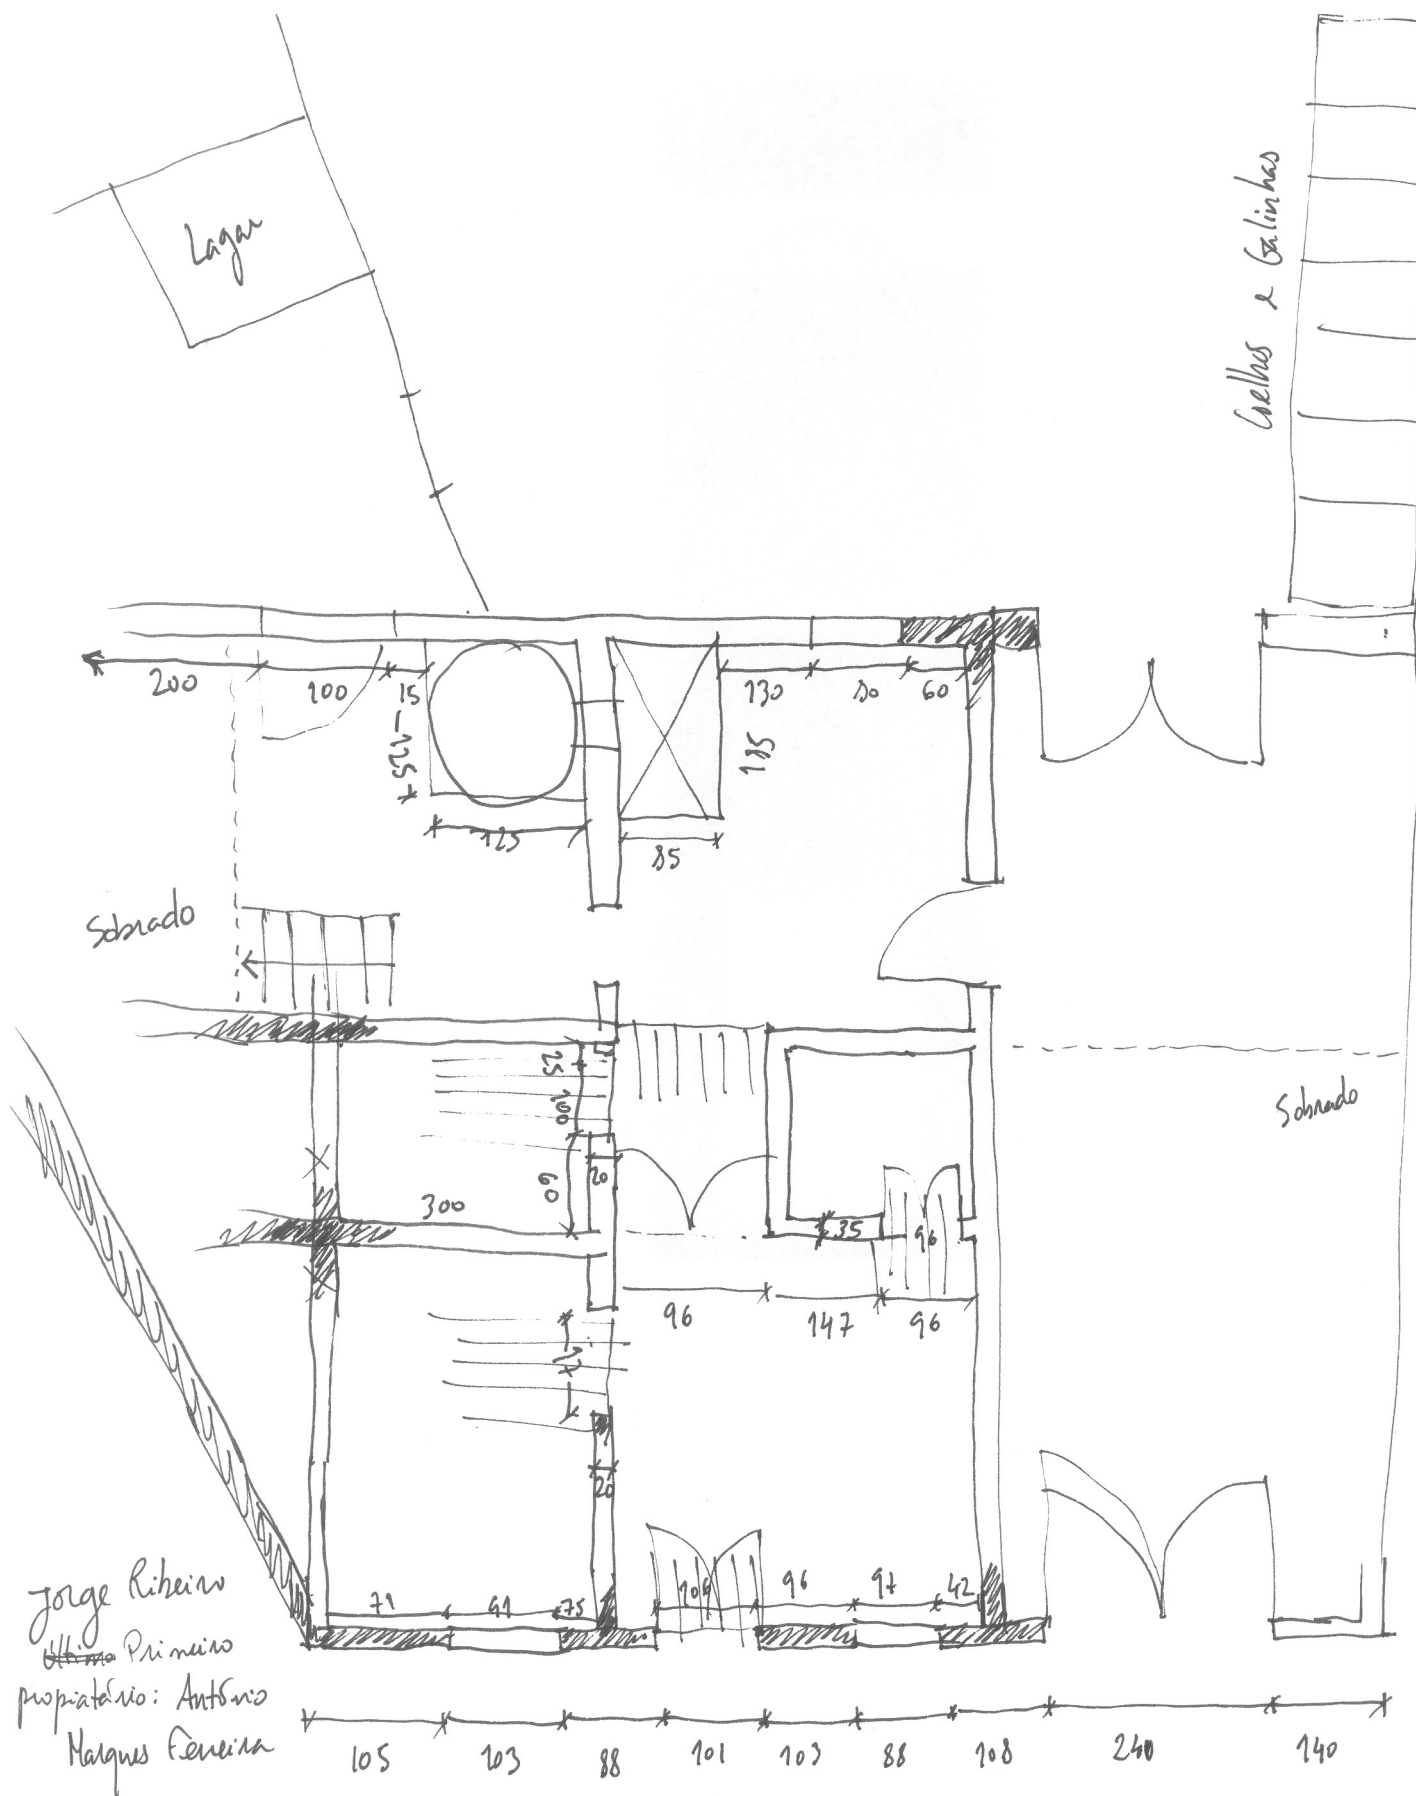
Planta de levantamento. Casa Pátio [Aveiro5], pág. 90
